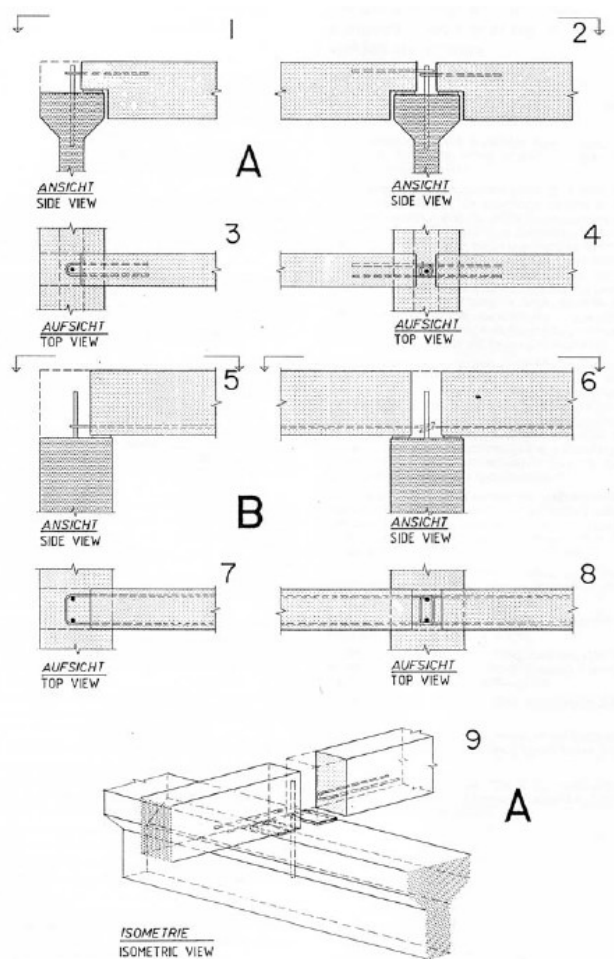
Ligação com armaduras em gancho (Stupré, 1981)
